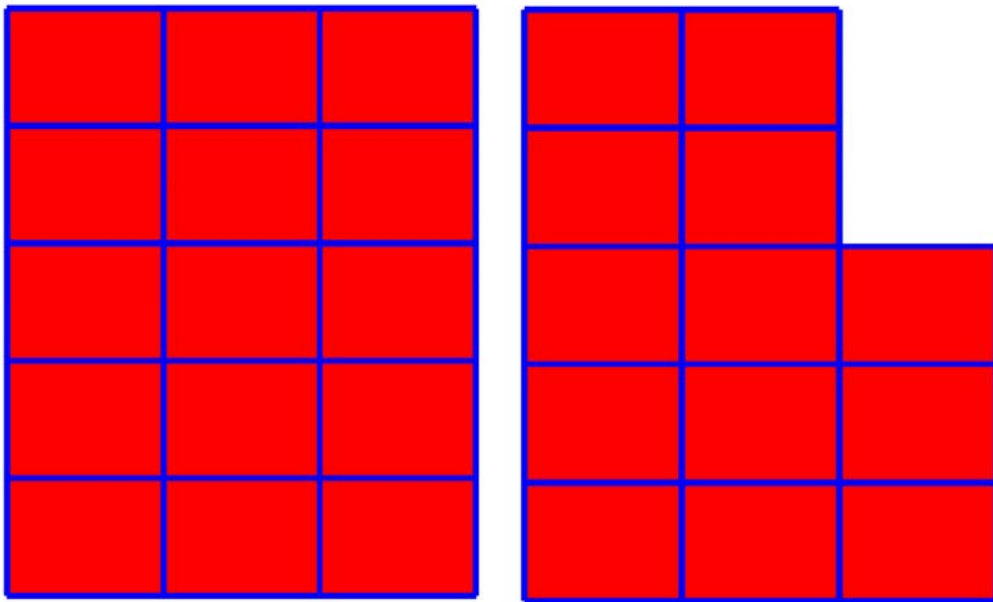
Planta rectangular del 1er y 2do piso y planta en L del 3er y 4to piso.
